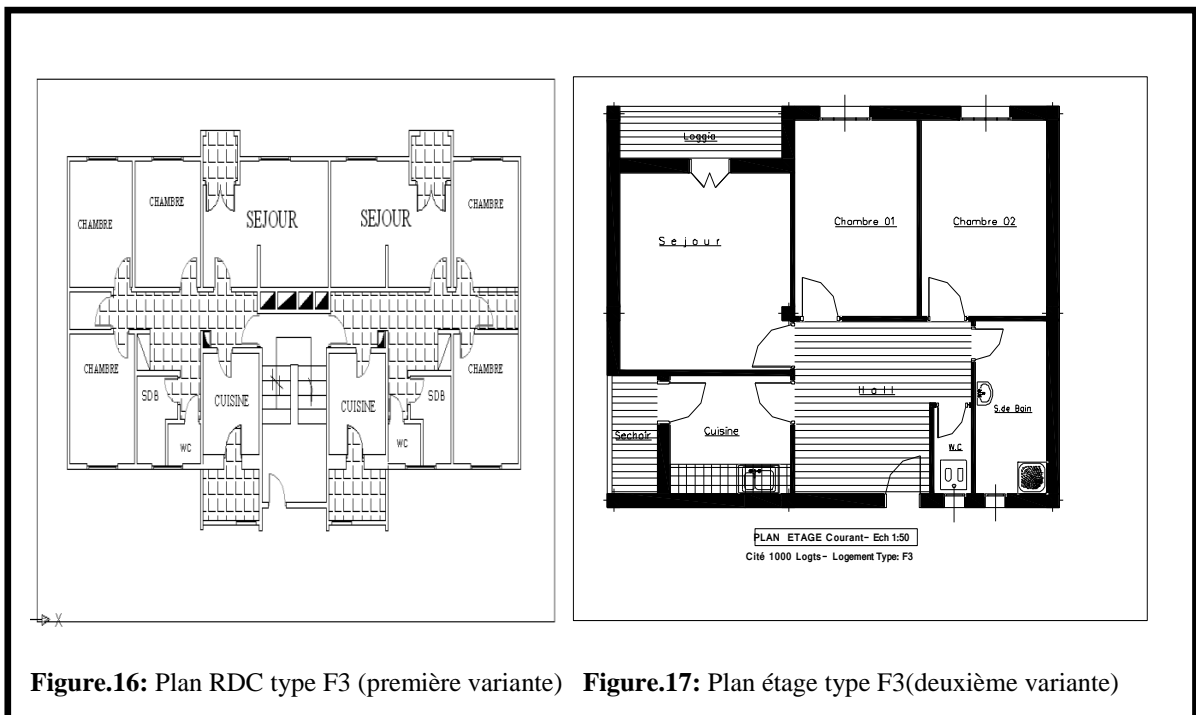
Plan RDC type F3 (première variante) Figure.17: Plan étage type F3(deuxième variante)
